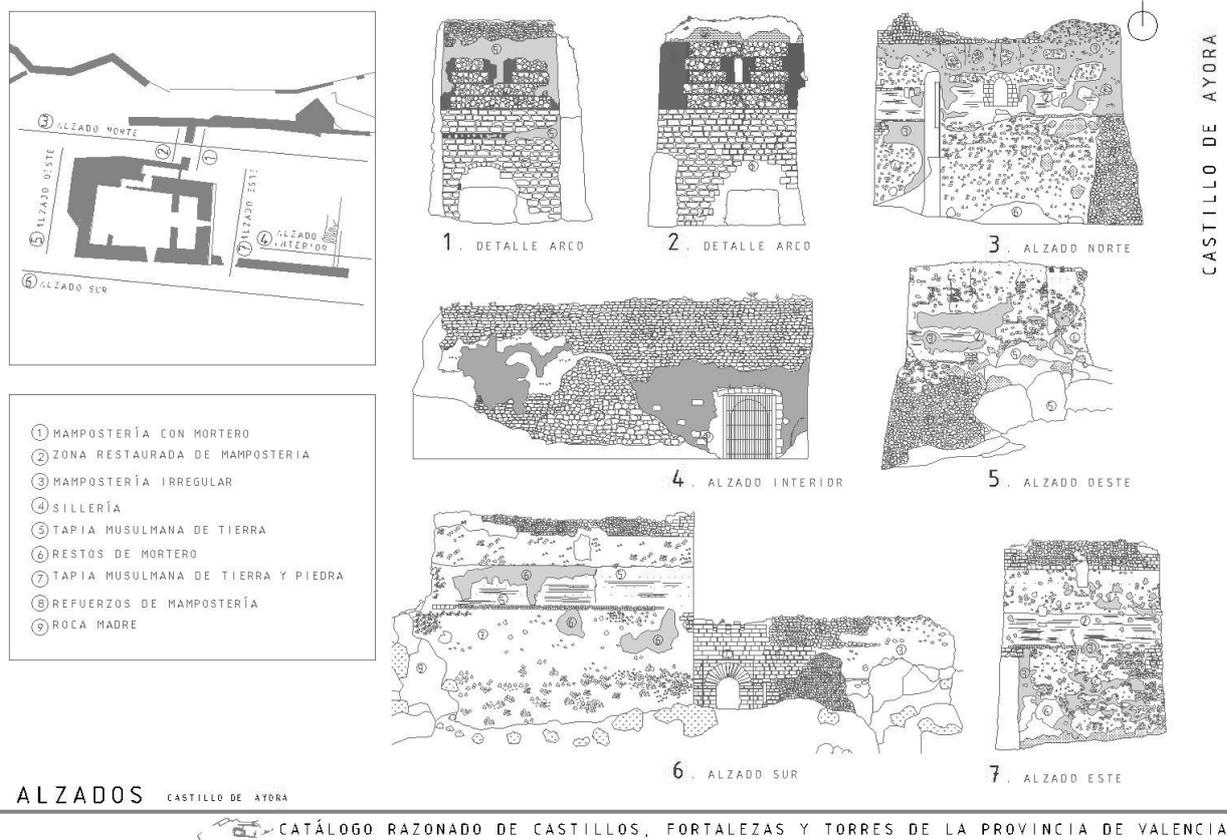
Ficha de los alzados y secciones del castillo de Ayora. En todas las fichas de alzados aparece un esquema en planta identificando el alzado, la caracterización de materiales y la manifestación patológica
